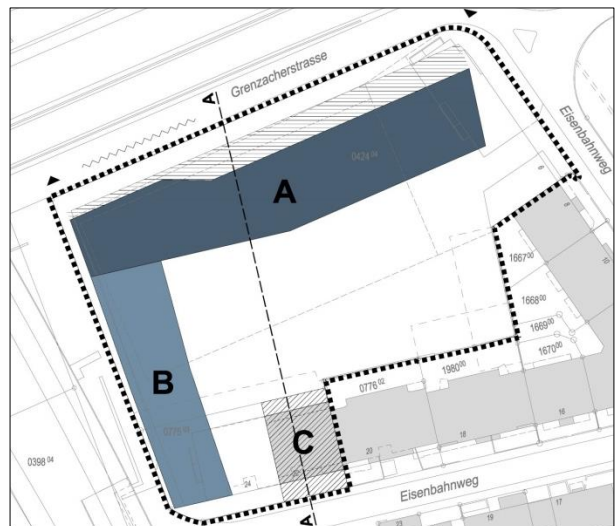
Neuer Bebauungsplan Plan Nr. 14'127
